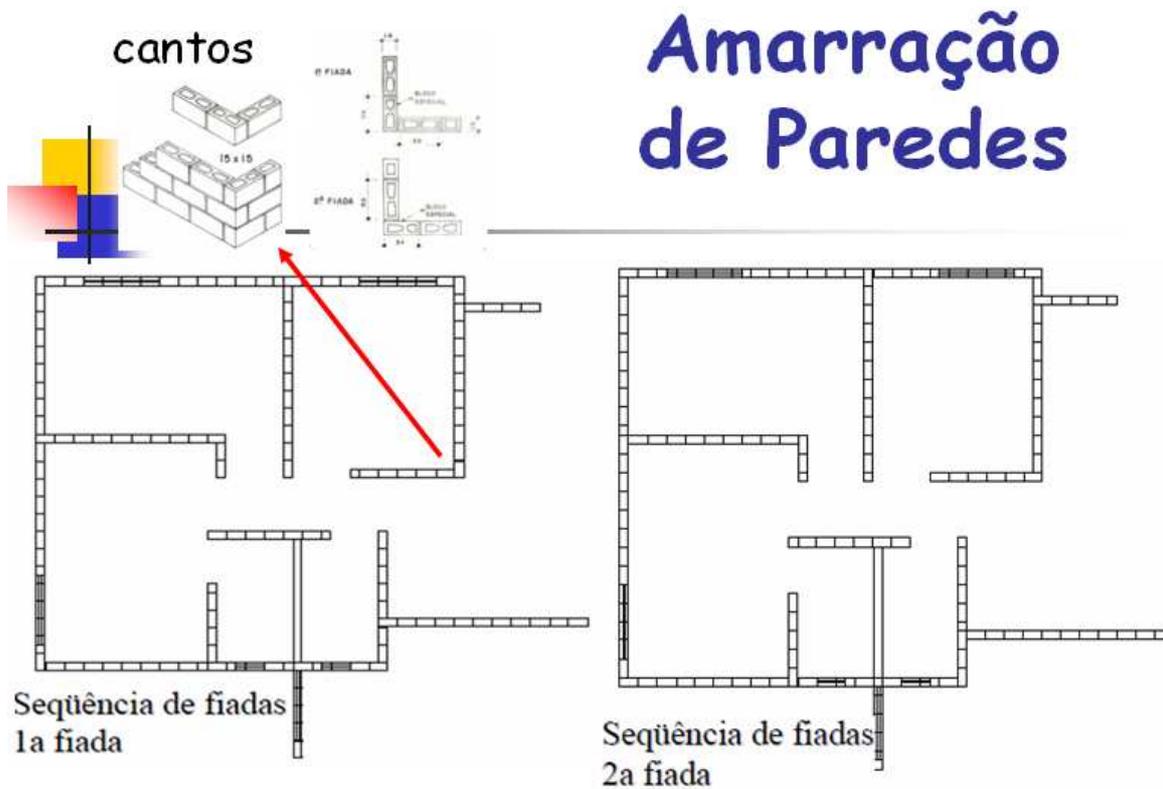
Modulação de um pavimento com amarração de canto
